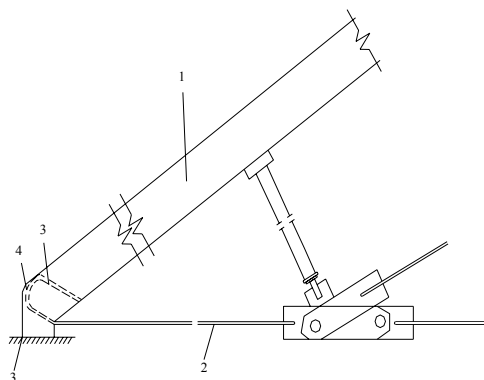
Опорний вузол комбінованої ферми: 1 – верхній залізобетонний пояс; 2 – металічна стяжка; 3 - крюк; 4 – паз
